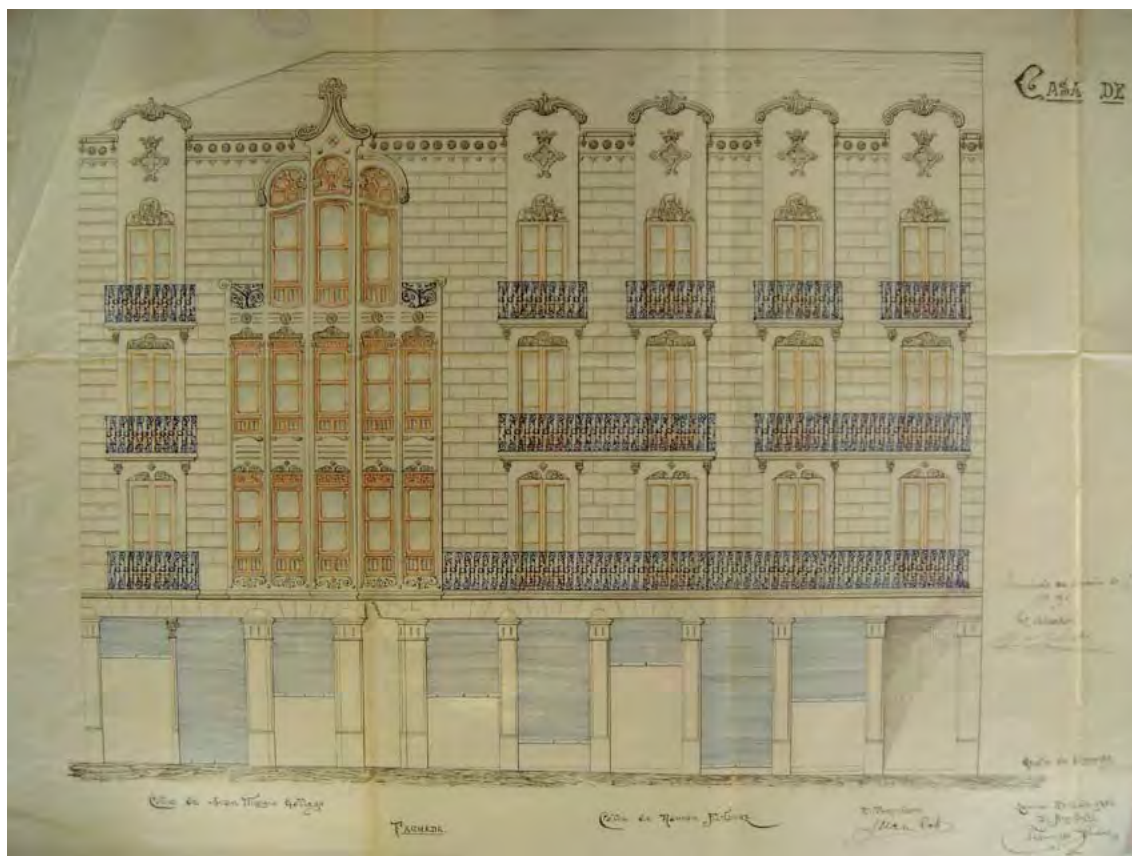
Plano de fachada de la Casa Gato (1912). Arquitecto Francesc Ferrer
